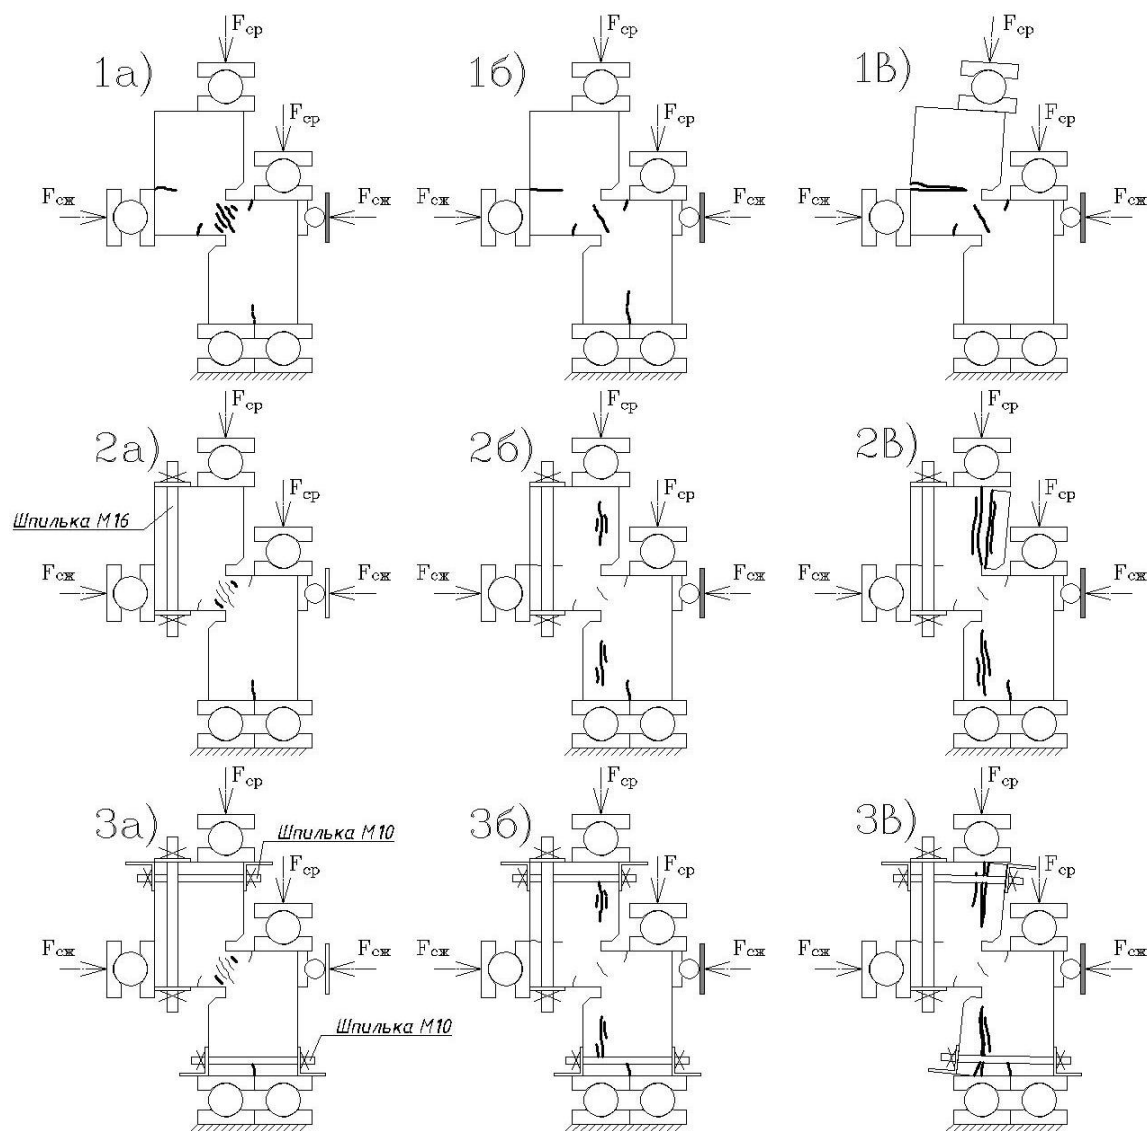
Схемы разрушения экспериментальных образцов с указанием элементов внешнего армирования
